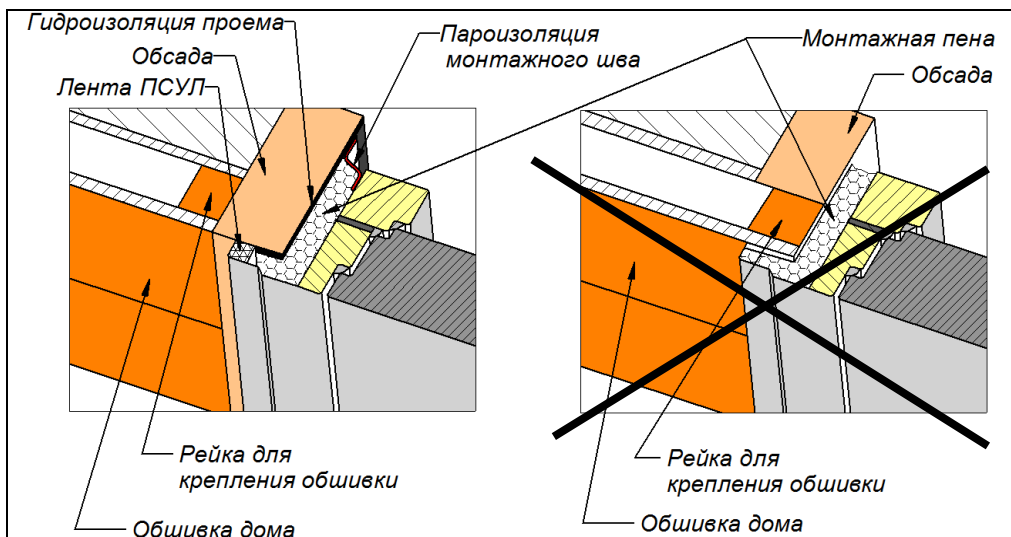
Схема ПРАВИЛЬНОГО монтажа дверного блока в проеме каркасного дома (Выполнена гидроизоляция проема, наклеена лента ПСУЛ по периметру наличника, выполнена пароизоляция монтажного шва)
